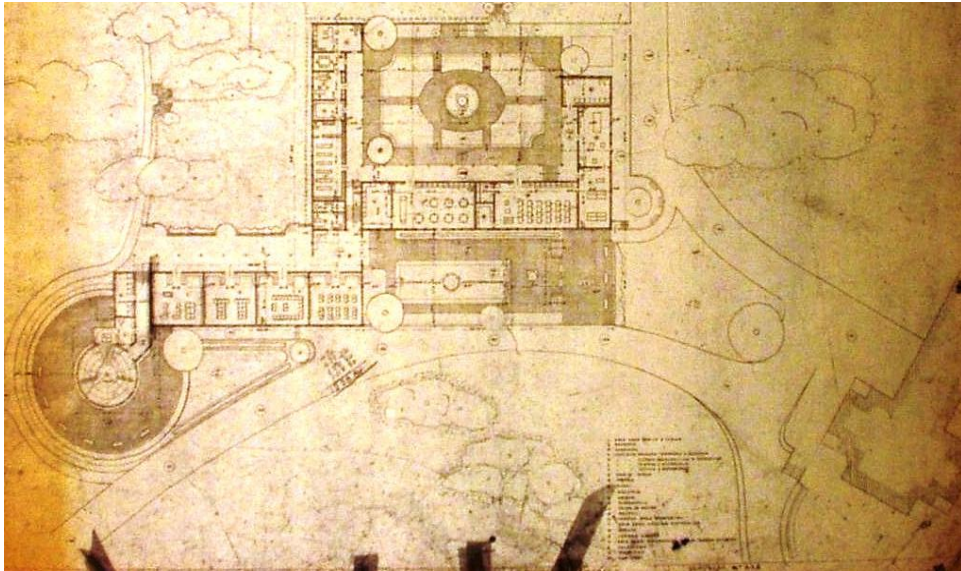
Grundriss des Unterrichtgebäudes und Kapelle der Normalschule in Pamplona.
